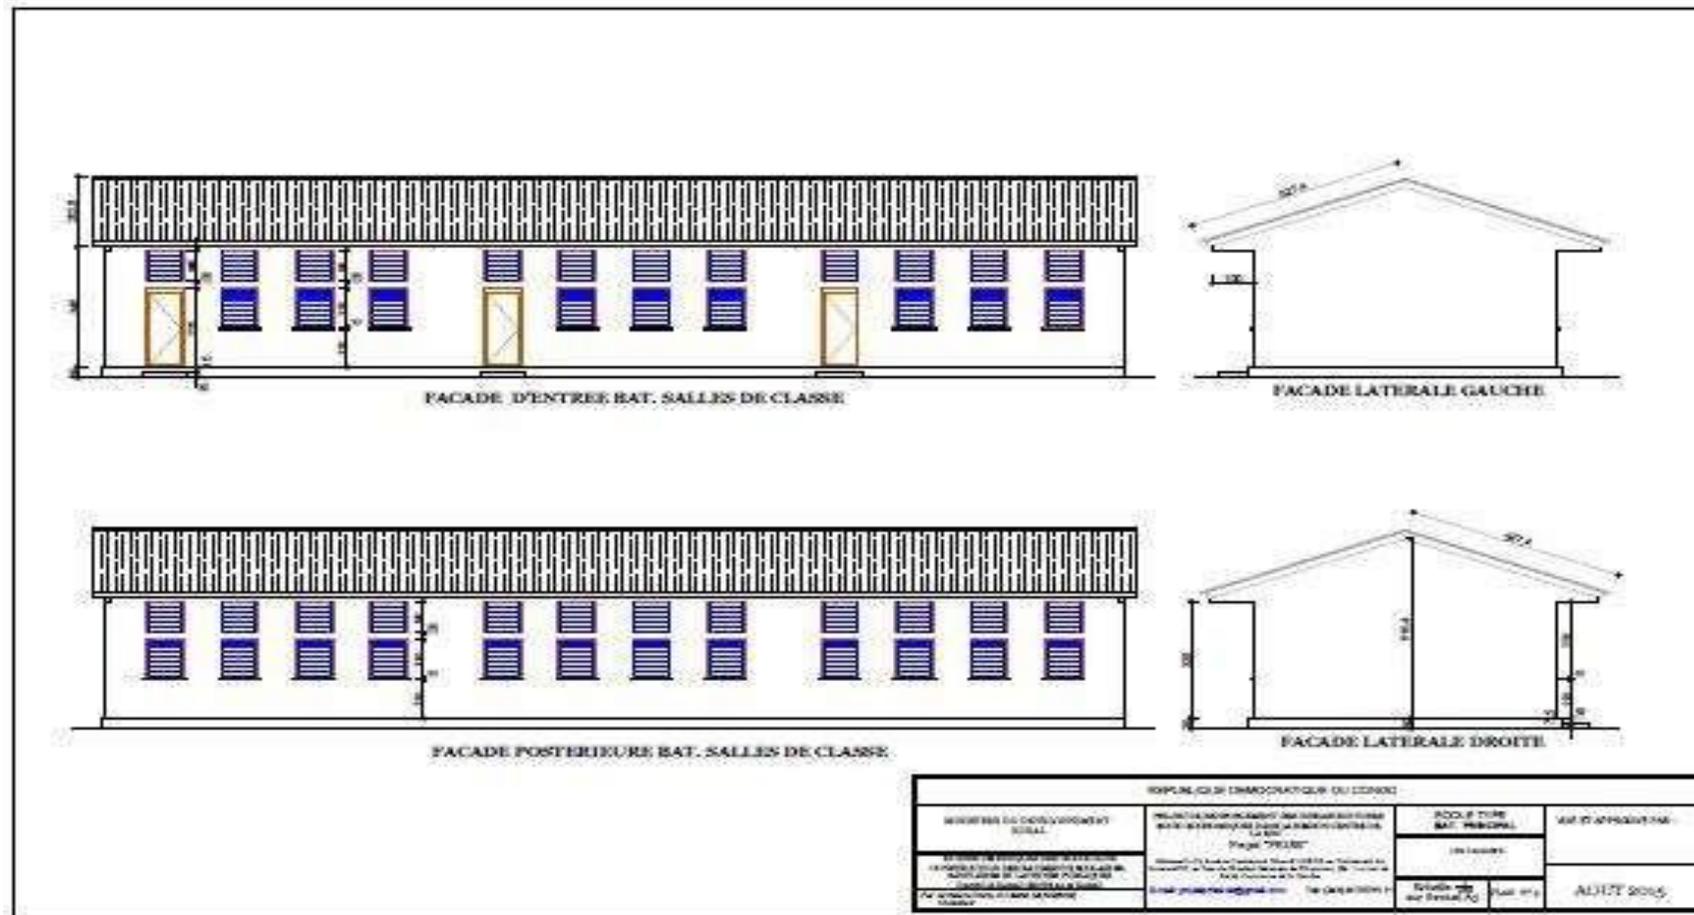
Les façades d'entrée et postérieure des bâtiments à construire
